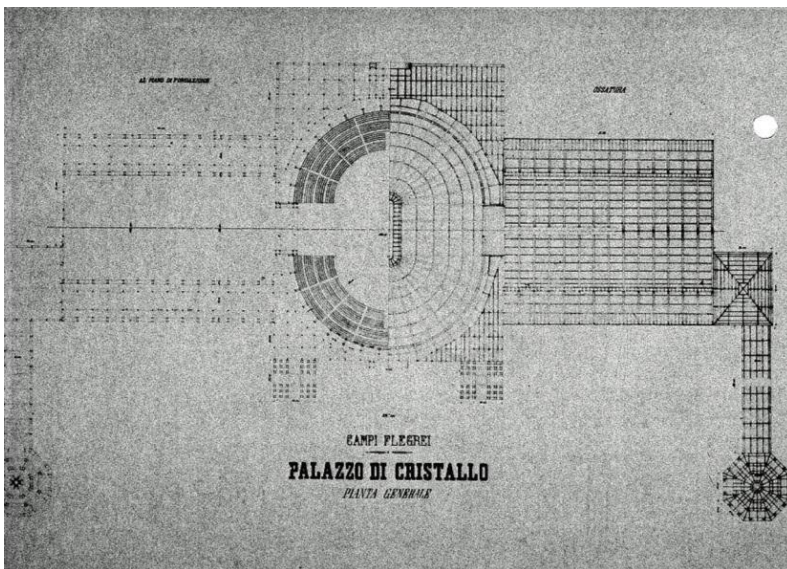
Grundriss des Kristallpalastes. Lamont Young. Neapel. 1888
